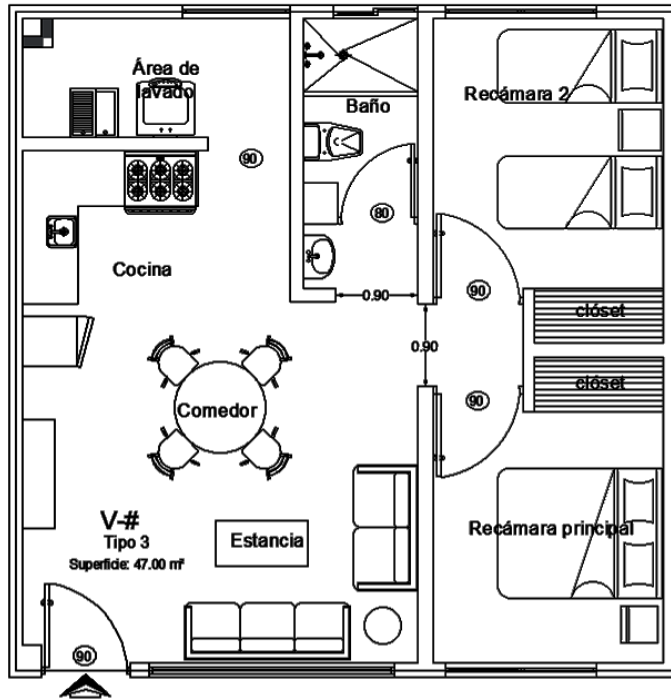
Vivienda Tipo 3 del Conjunto de vivienda propuesto en la Col. Morelos.
